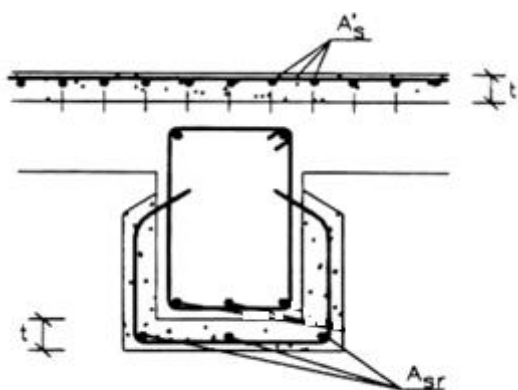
Reforço por encamisamento de betão em vigas e lajes [7]
